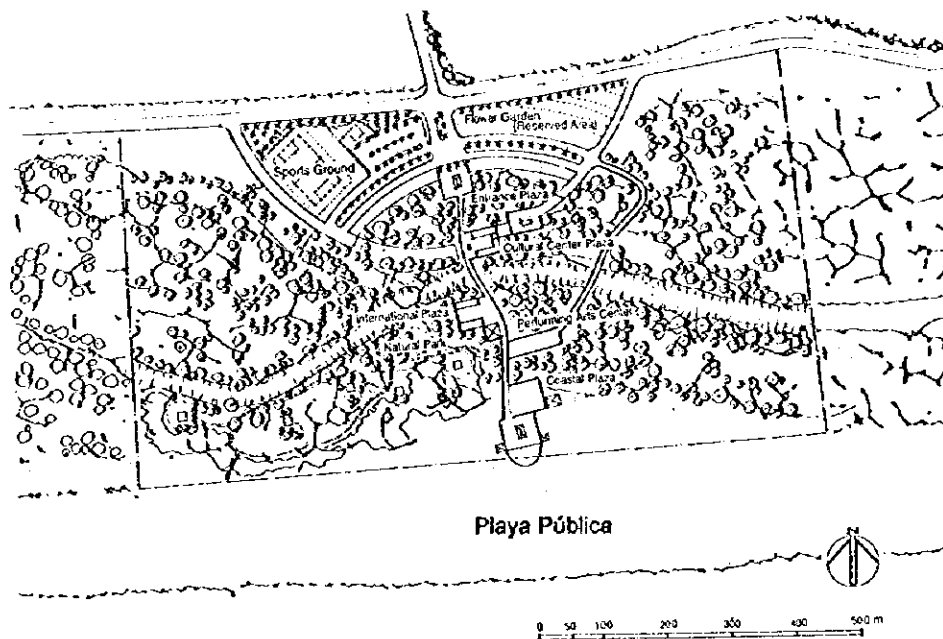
Imagen de Desarrollo para el Centro de Diversión
